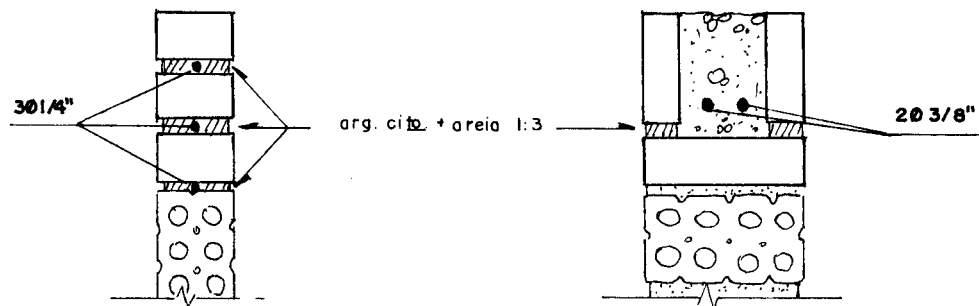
Cinta de amarração em alvenaria de tijolo furado
